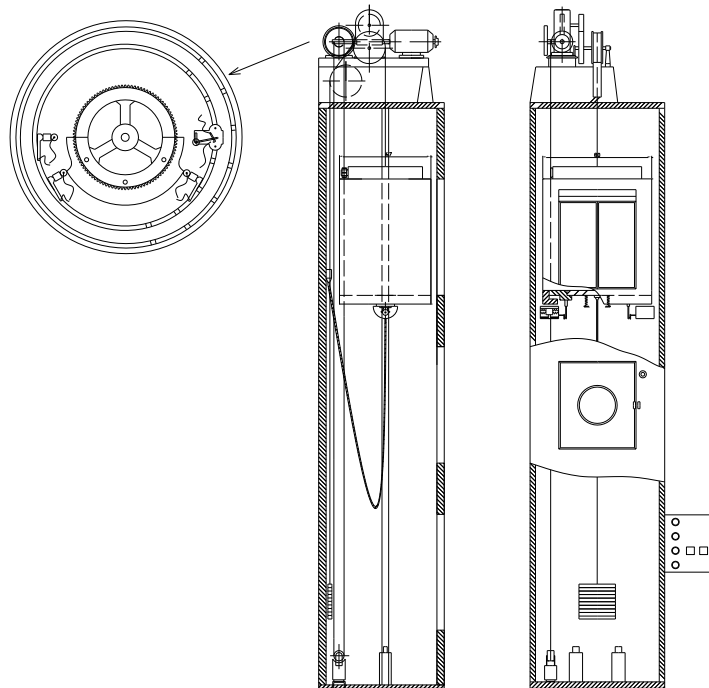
Загальний вид і кінематична схема лабораторного макета ліфтової установки
